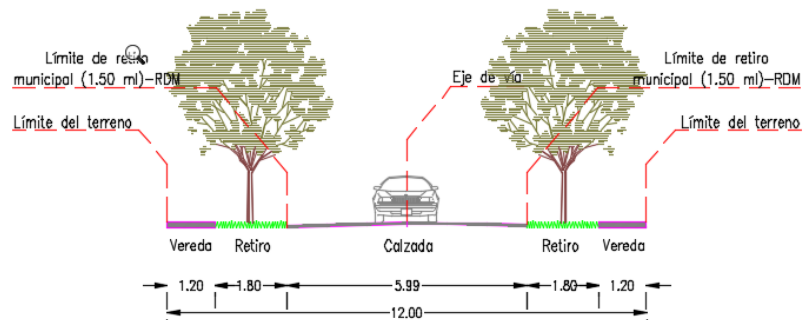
SECCION A-A (AV. LAS GARDENIAS)
